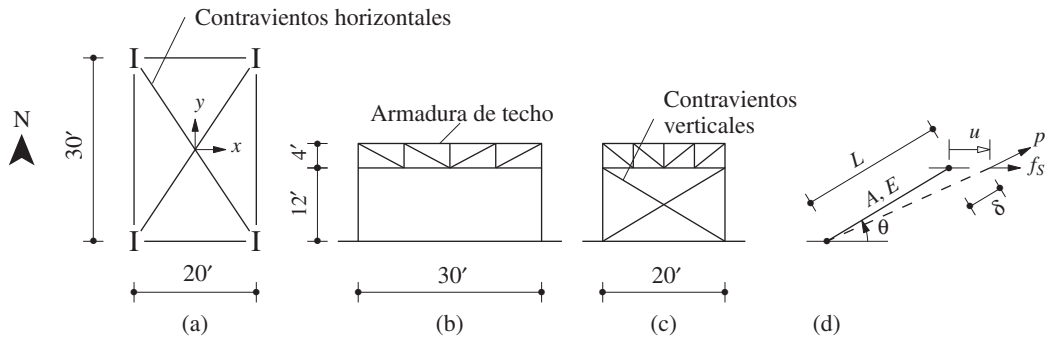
(a) Planta; (b) elevaciones este y oeste; (c) elevaciones norte y sur; (d) contra-viento.
